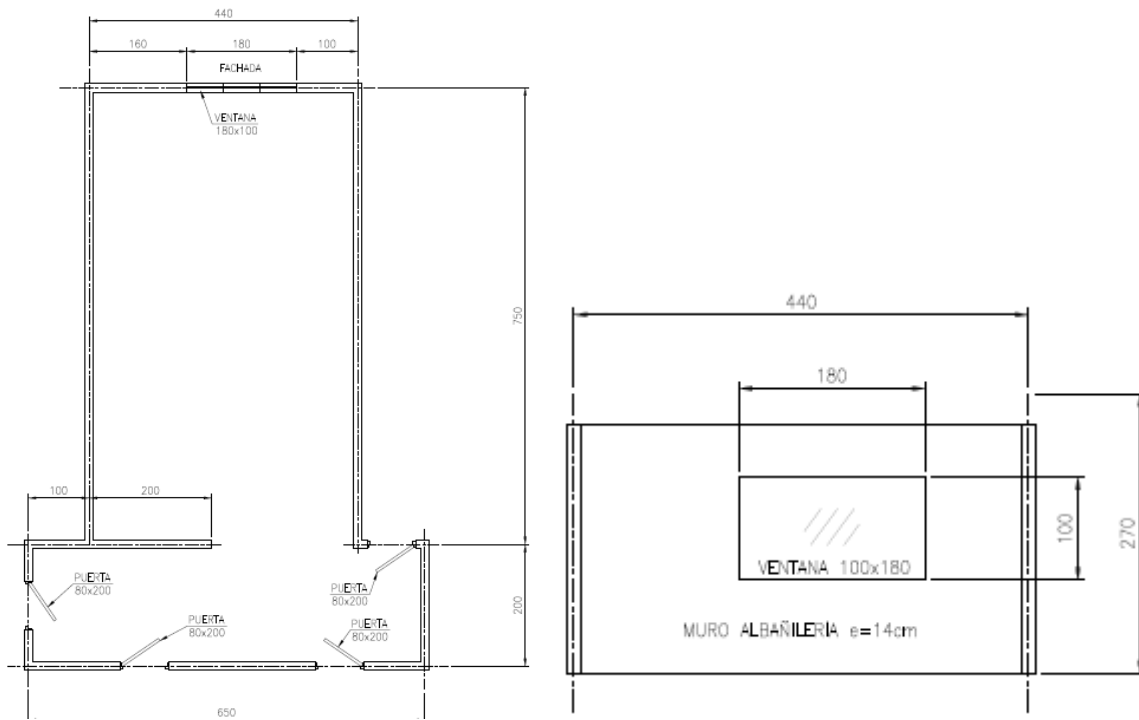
Vista en planta y elevación del recinto utilizado para el ensayo.
